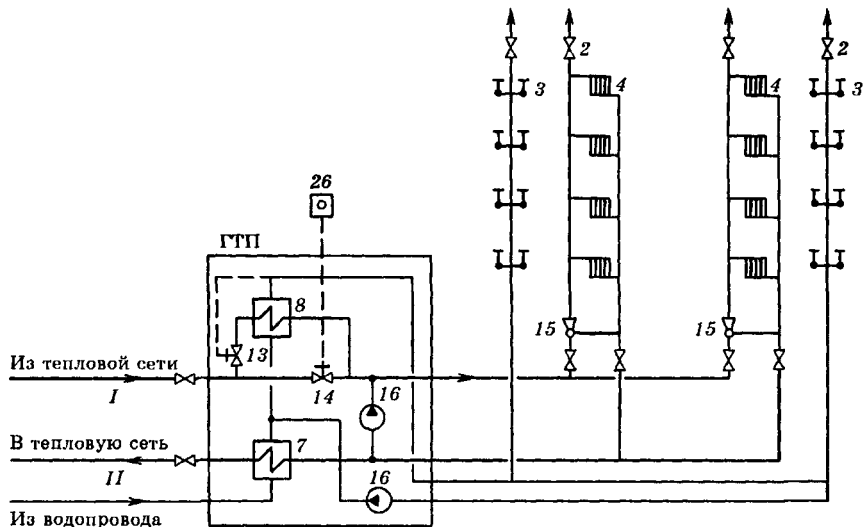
Схема присоединения к тепловой сети систем отопления и горячего водоснабжения группы зданий через ГТП
